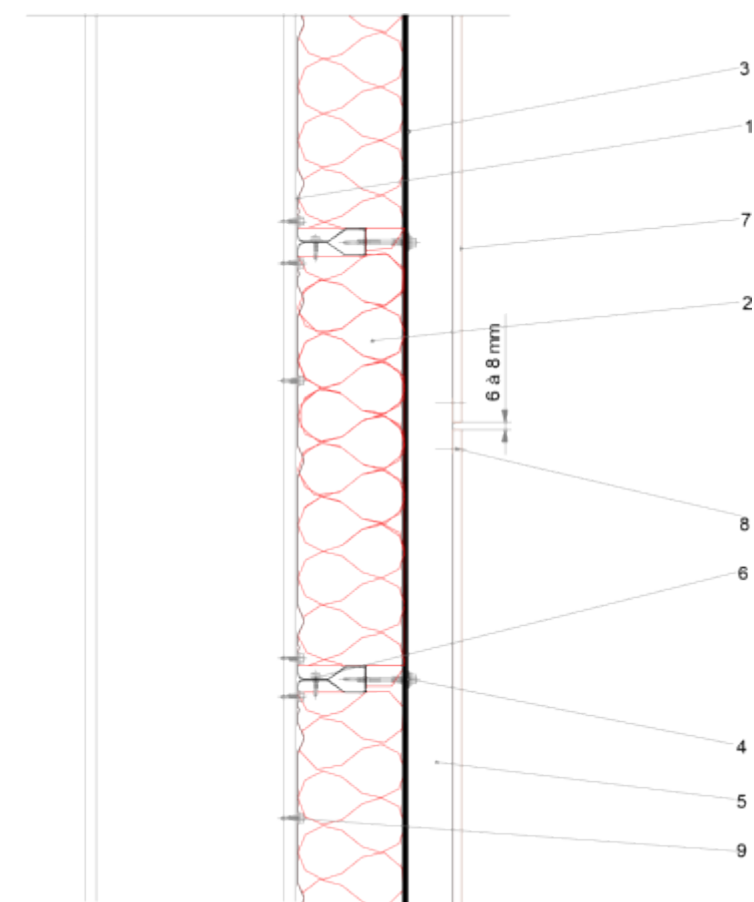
is – Coupe verticale en partie courante avec panneau EQUITONE (avec membrane de protection DELTA FASSADE 20 PLUS)
